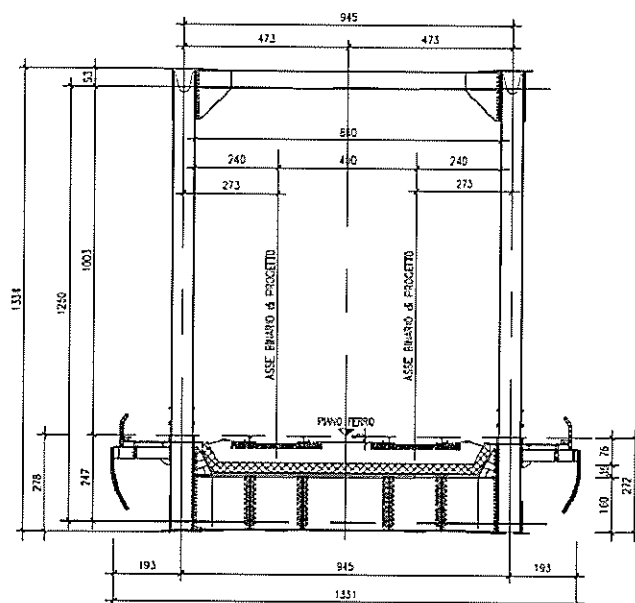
Impalcato in acciaio - cls: sezione trasversale
